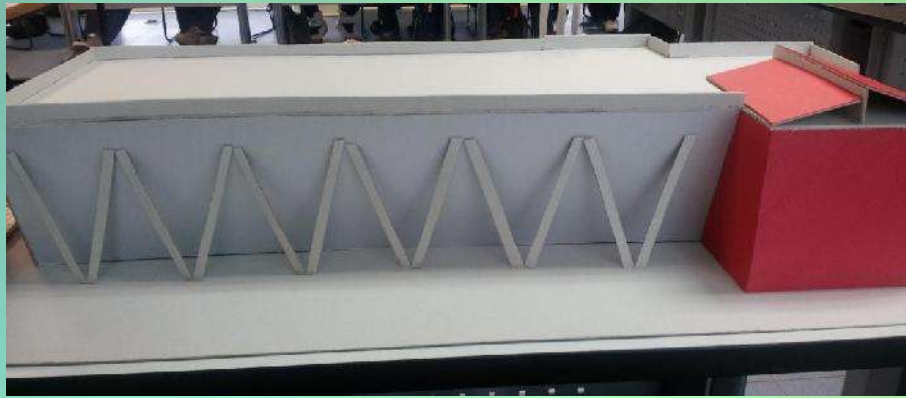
, Maqueta Conceptual Fachada Norte, Foto EDGM
